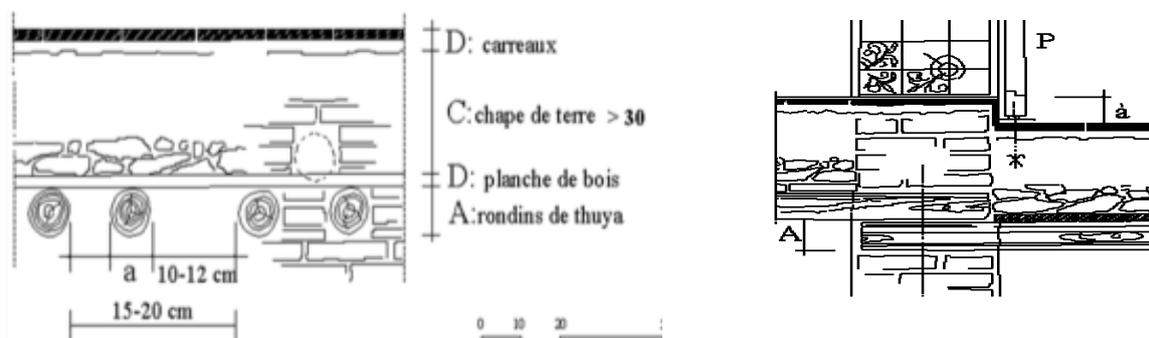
A gauche : plancher type de la médina, à droite Surélévation du plancher des chambres (Source: A. Ravéreau).
